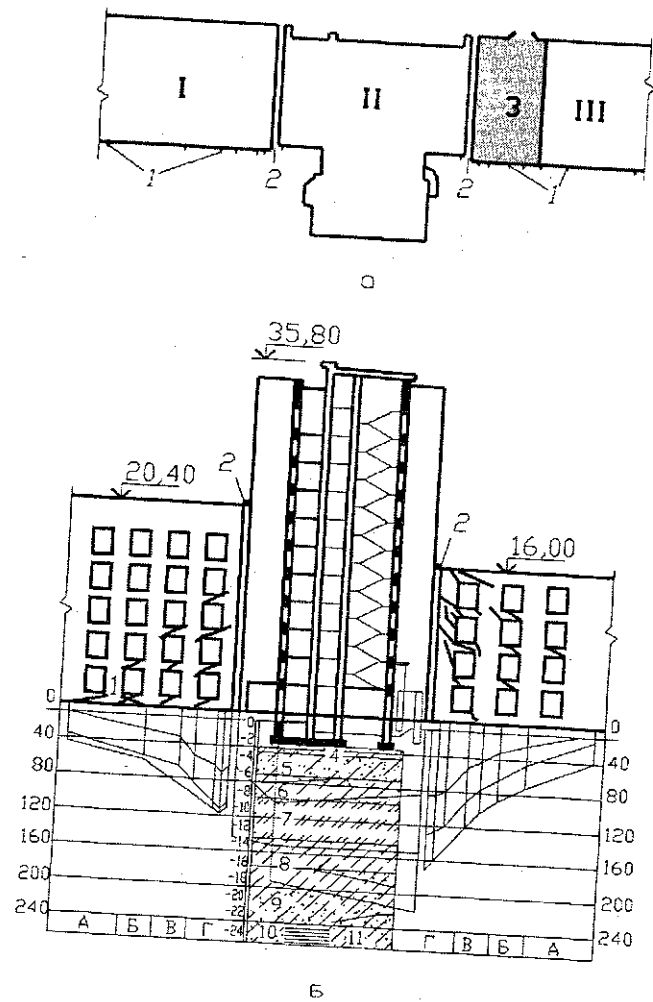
Повреждения стен двух домов старой постройки, между которыми был возведен новый дом: а — план здания; б — разрез нового здания и его основания; I — III — номера корпусов; 1 — деформационные марки; 2 — осадочные швы; 3 — участок четырехэтажного здания, получивший аварийные повреждения, разобранный и восстановленный в 1980 г.
